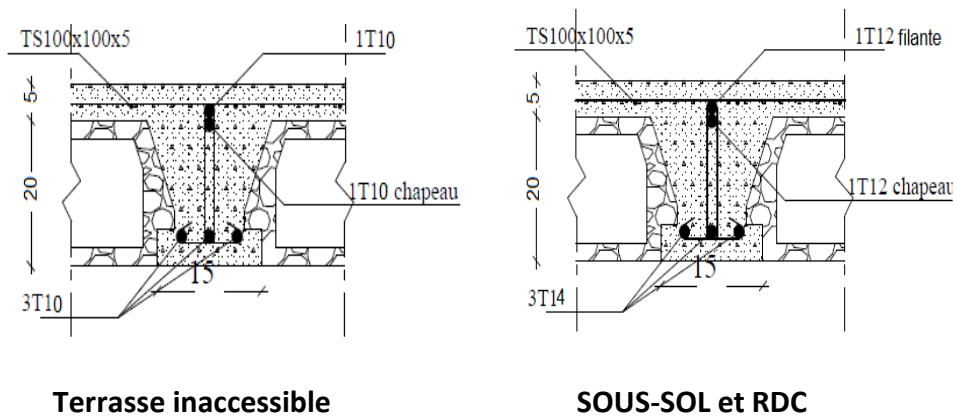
Dessin de ferrailage des poutrelles de plancher de bloc B
